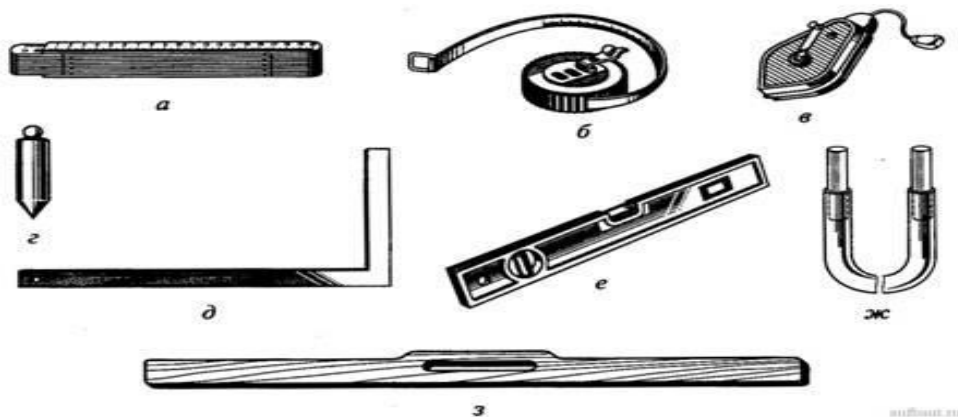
Інструменти для вимірювання та перевірки поверхонь:
